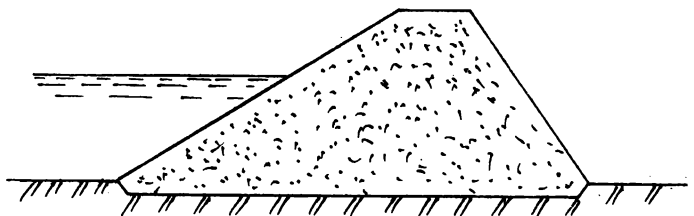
Поперечное сечение дамбы из однородных грунтов
